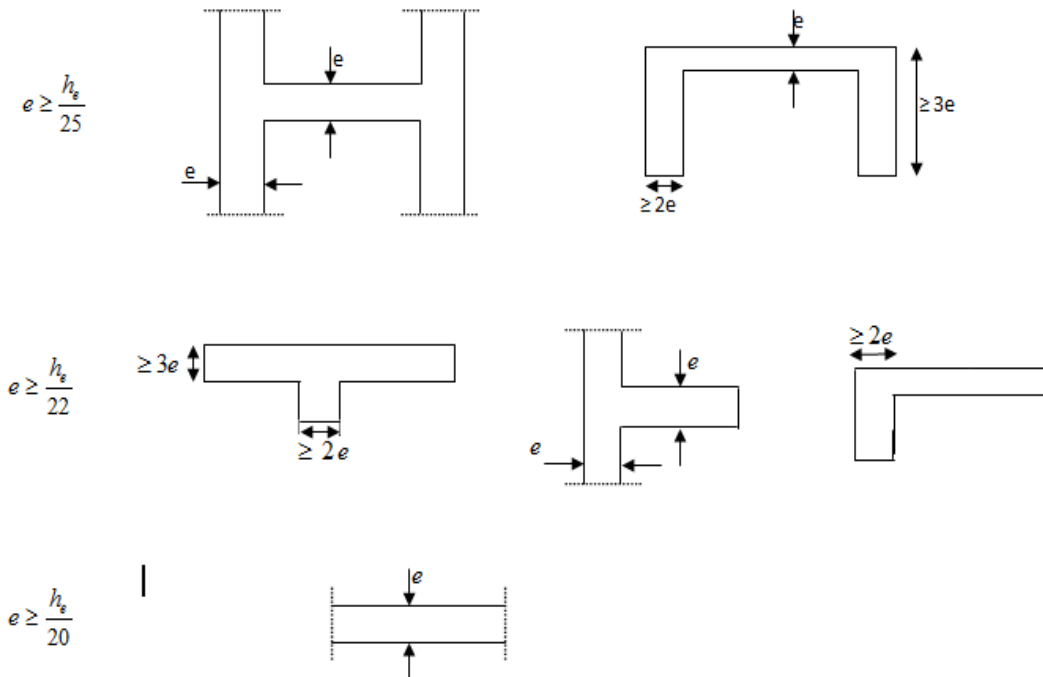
Coupe Verticale des Types des Voiles en Plan
